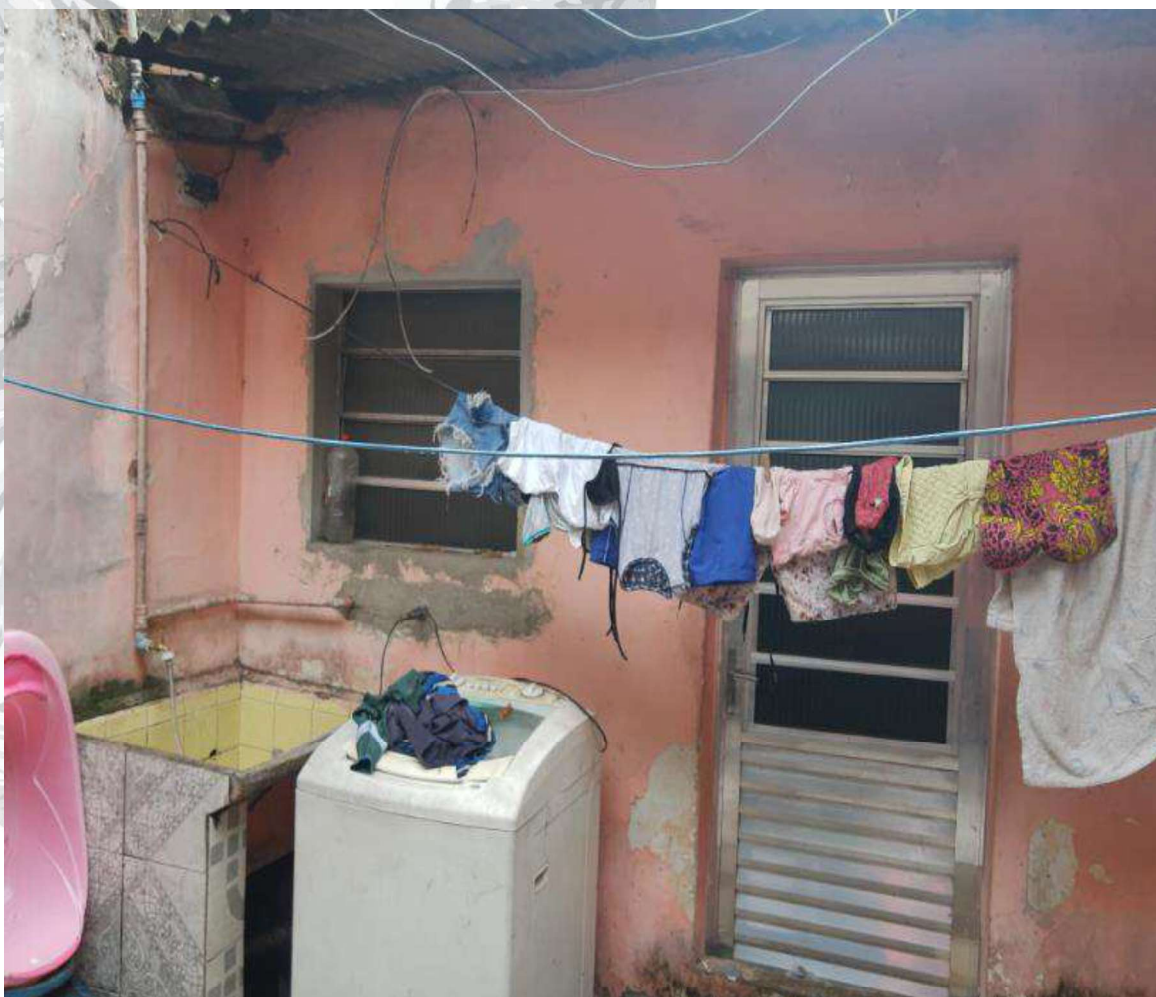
FOTO ÁREA EXTERNA FUNDOS LAVANDERIA
